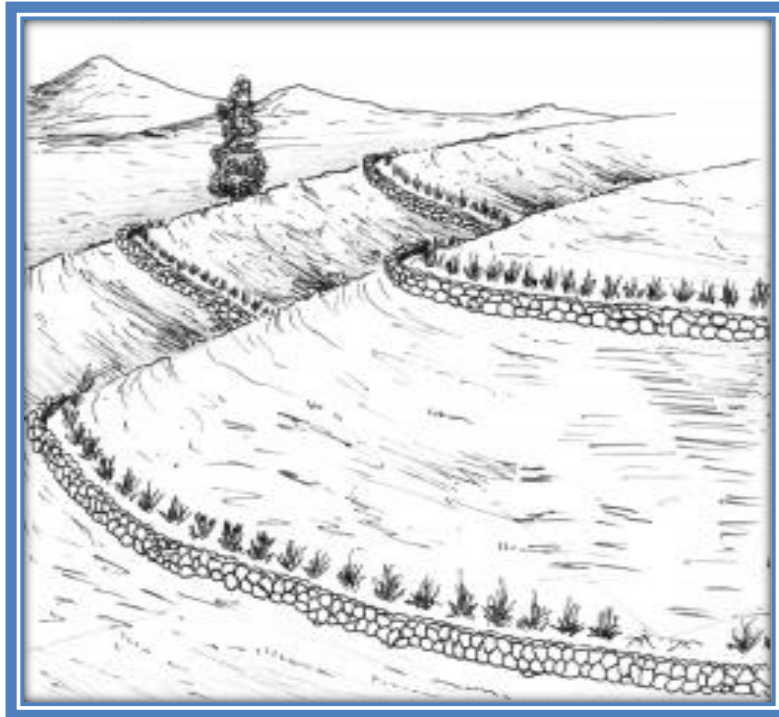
BARRERAS MUERTAS DE PIEDRA.
